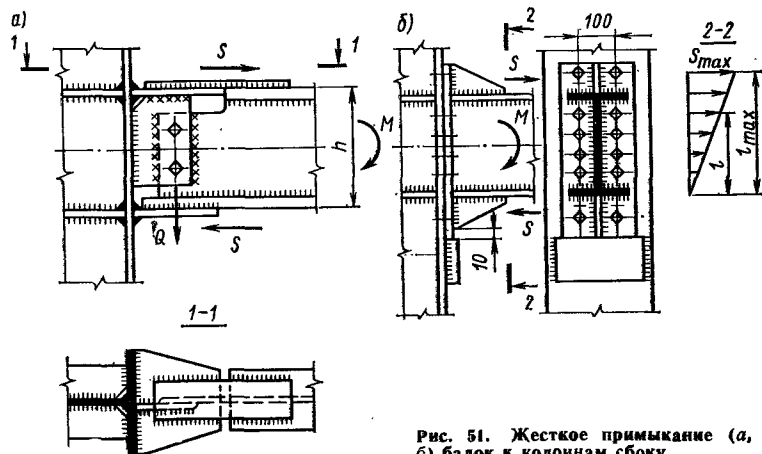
Жесткое примыкание (а, б) балок к колоннам сбоку
